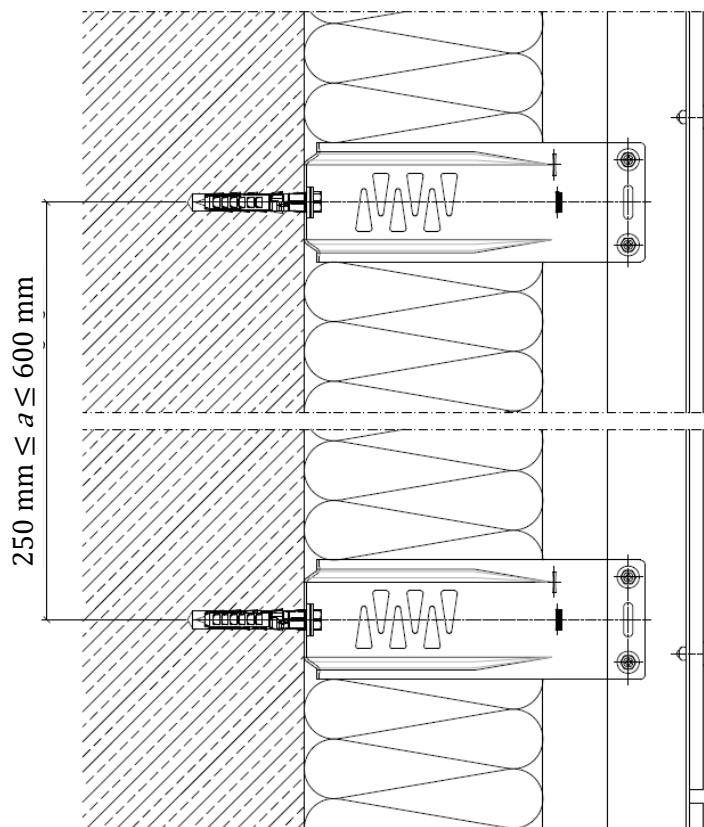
FLH Lx70 R Festpunkt-Ausführung E (ohne U-förmige Einlegescheibe)
